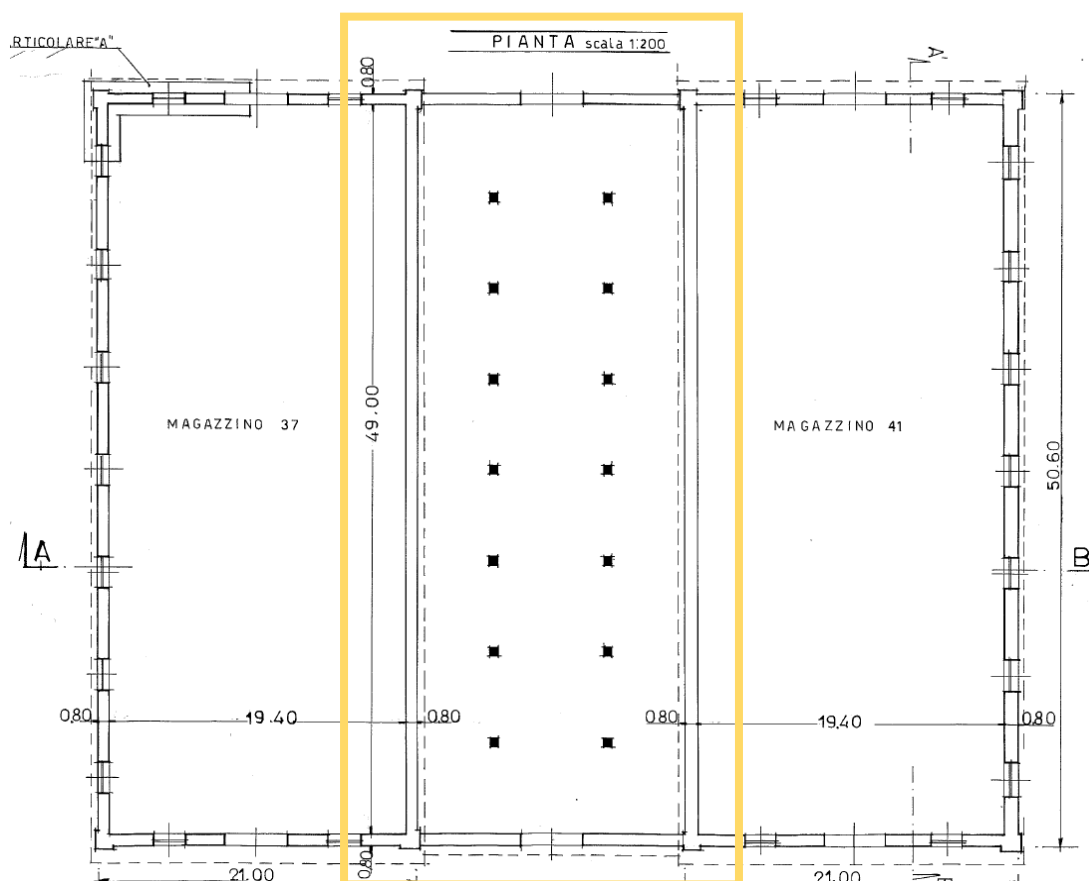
Planimetria lotto magazzini D38A, D39A e D40A
